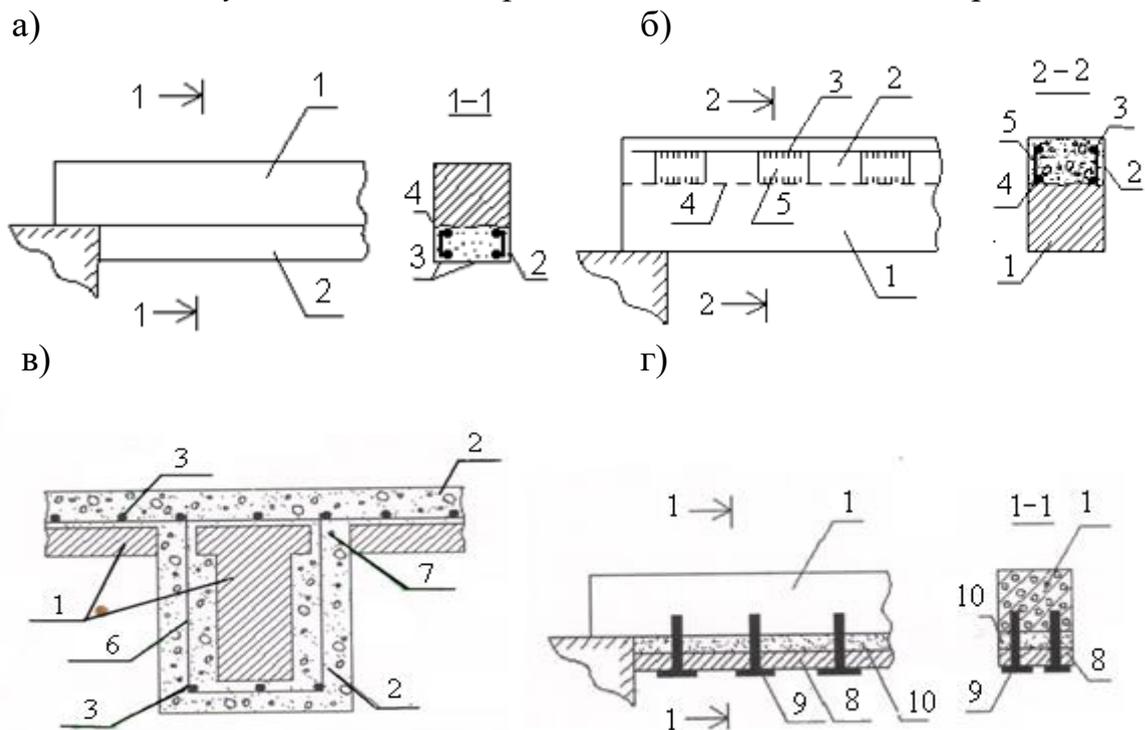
Схема усиления железобетонных балок путем увеличения поперечного сечения:
